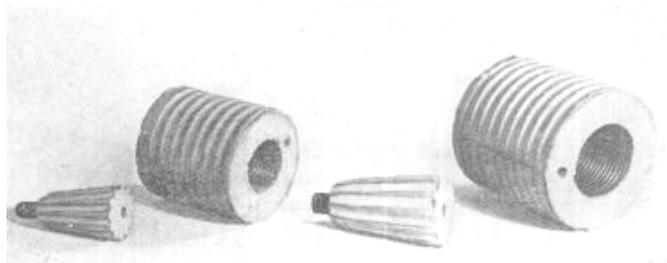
Piezas macho y hembra empleadas en el sistema Freyssinet.
